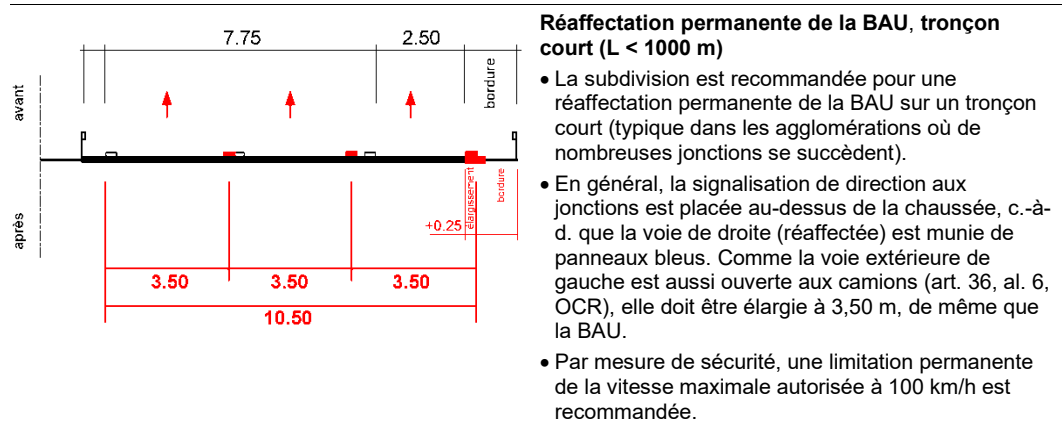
Subdivision de la chaussée en cas de réaffectation permanente de la BAU sur un tronçon court.
